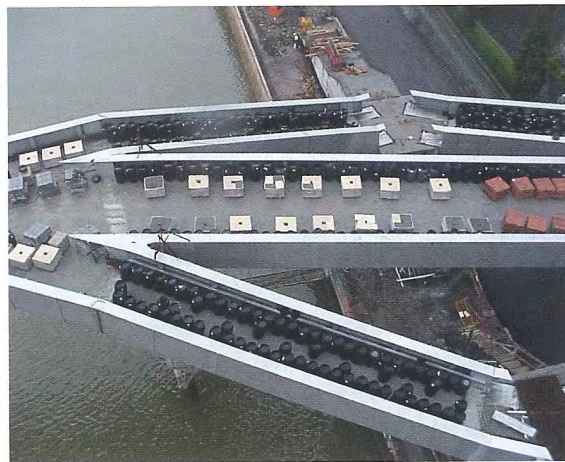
Mise en place de l'étanchéité / Waterproofing laying
